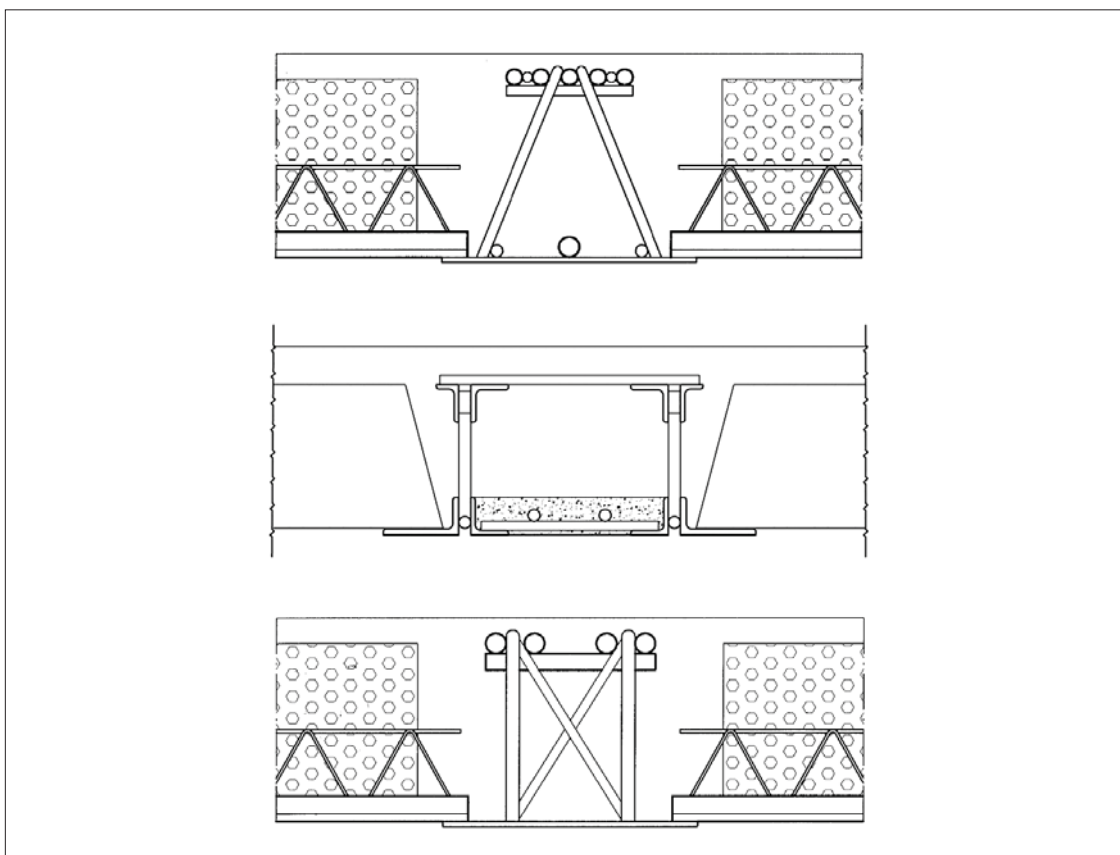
Travi in spessore con fondello in acciaio a ribasso.
